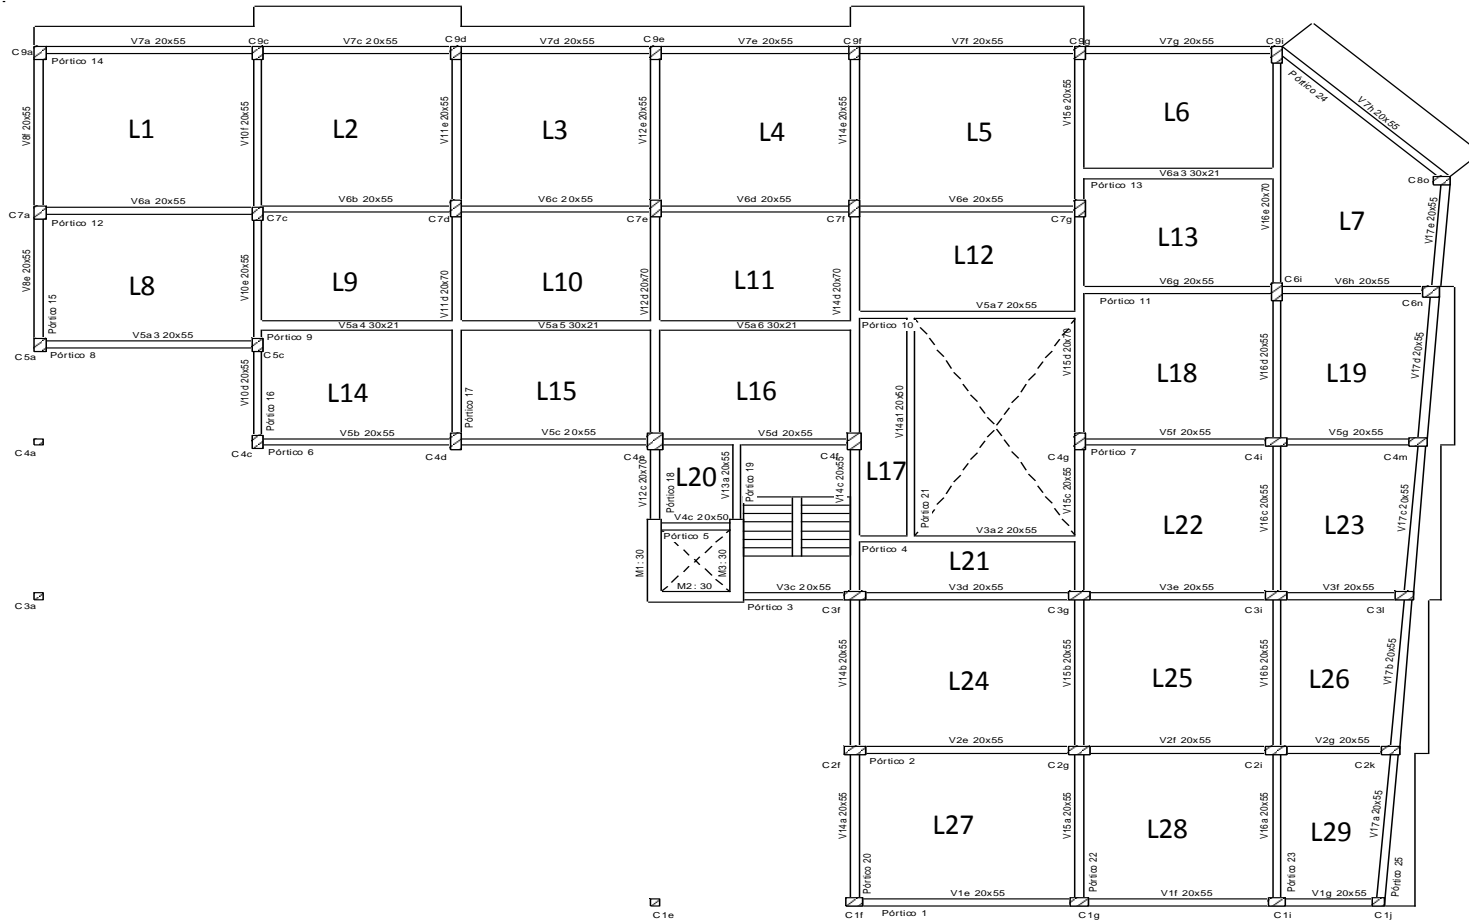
Plano Replanteo Piso 3,4 y 5
